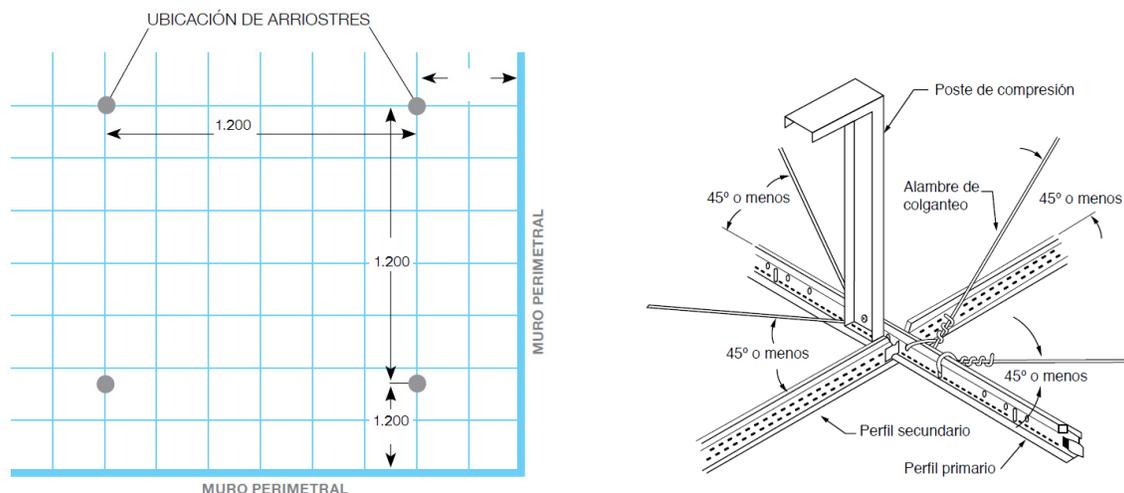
Ubicación arriostres en planta – Detalle típico arriostre.
